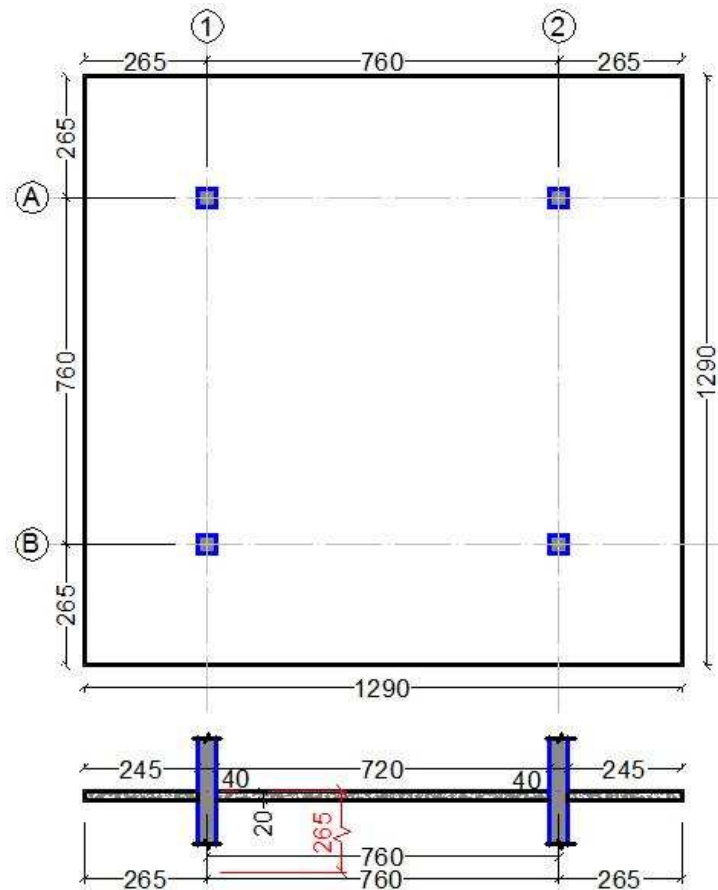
Planta baixa e elevação da FÔRMA_2
